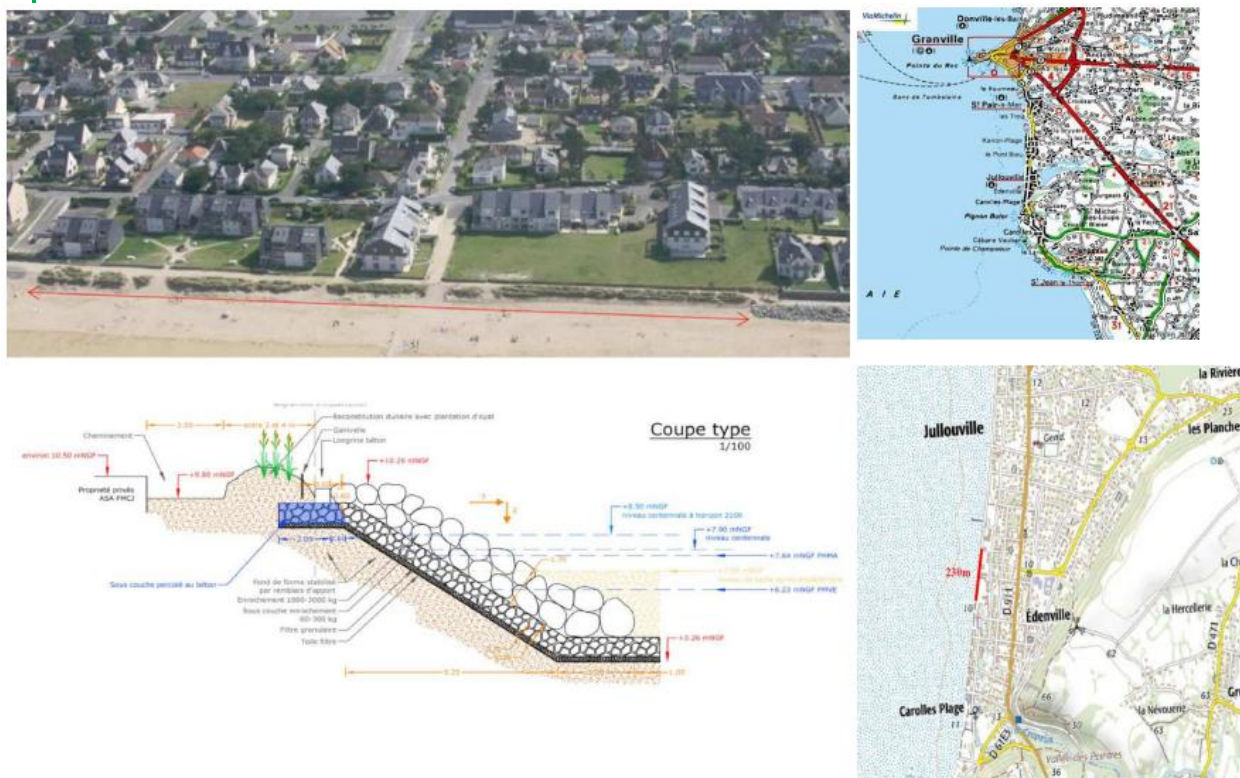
Localisation du projet de construction d'un ouvrage en enrochement
